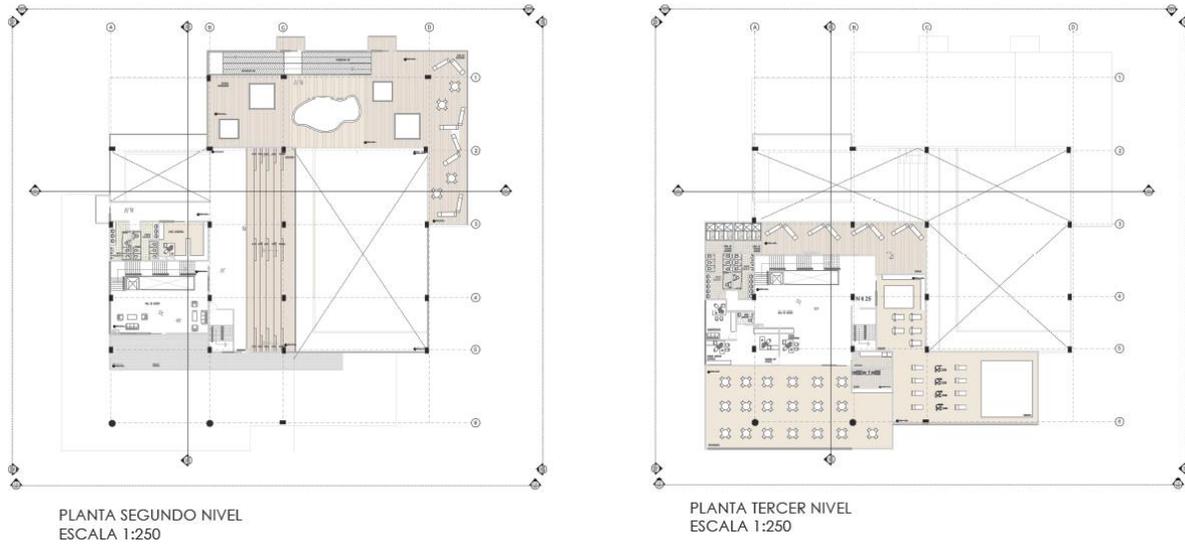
PLANTA SEGUNDO NIVEL Y PLANTA TERCER NIVEL
